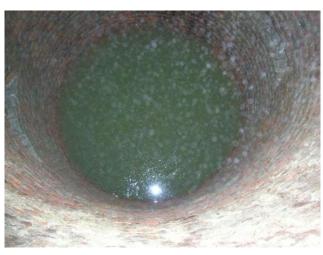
Puits à eau, proche du puits de Photo La Grille.
